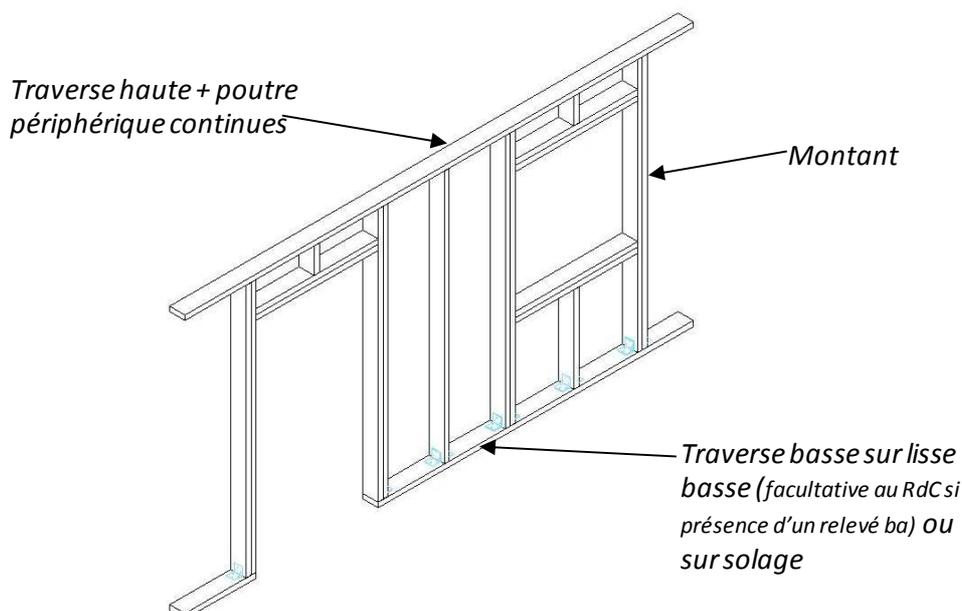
Schéma de principe de la conception de l'ossature d'un mur secondaire en façade
